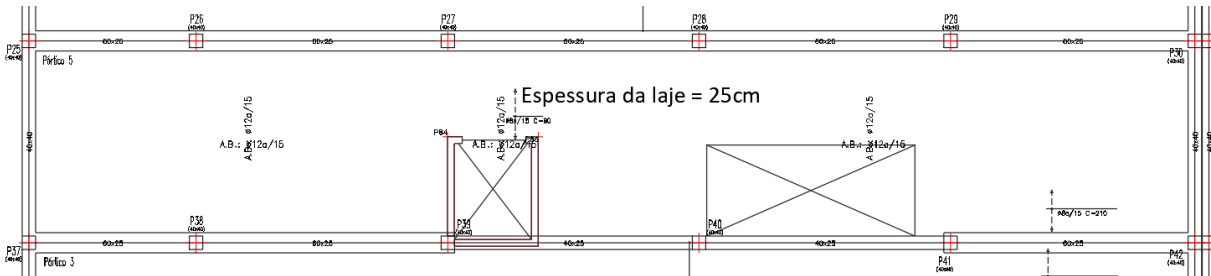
Pormenor do Pórtico 5 (Pilar P25 a P30) e Pórtico 3 (Pilar P37 a P42)
